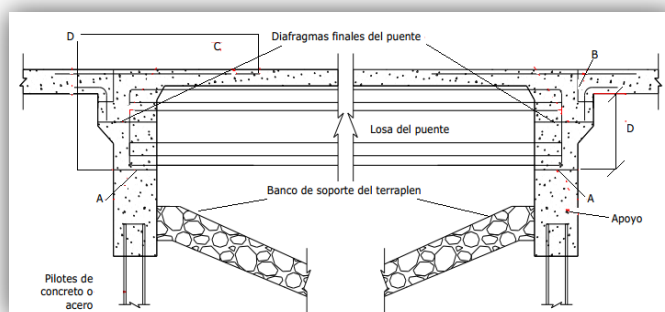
Construcción de juntas A, B, C y continuidad de la conexión en el estribo con la superestructura D
